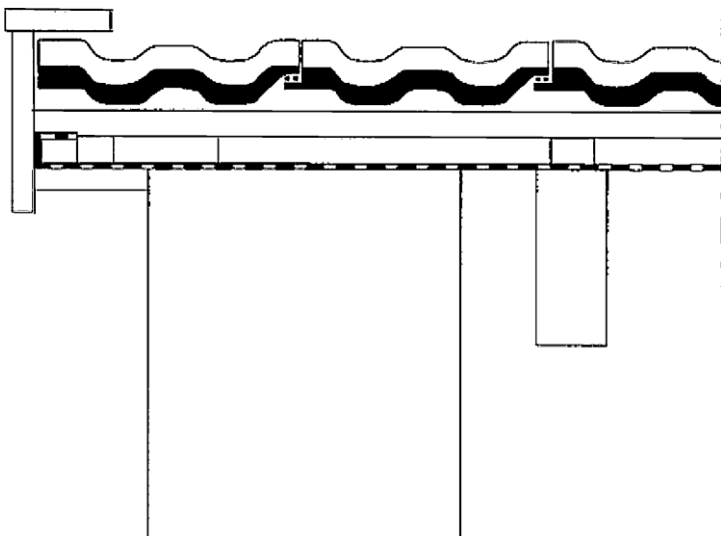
Ortgang mit Überstand mit Flächenziegeln, Flächensteinen oder Schlusssteinen, Abschluss Windbrett
